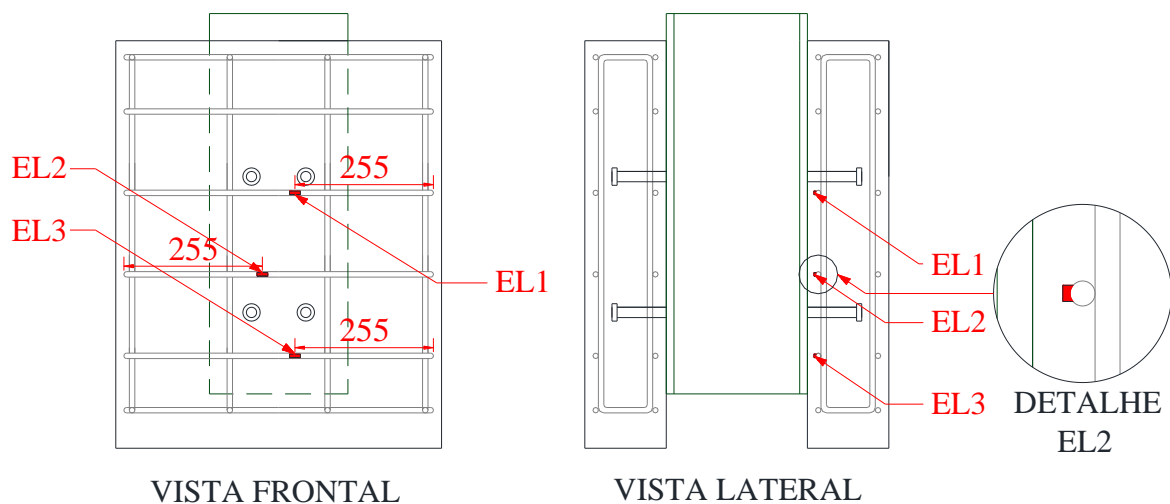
Disposição dos Extensômetros Elétricos de Resistência (EER) nas armaduras das lajes (dimensões em milímetros).
